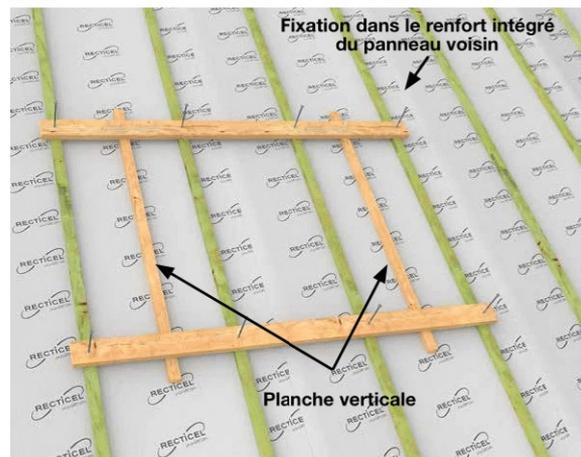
mise en place du chevêtre pour fenêtre de toit
